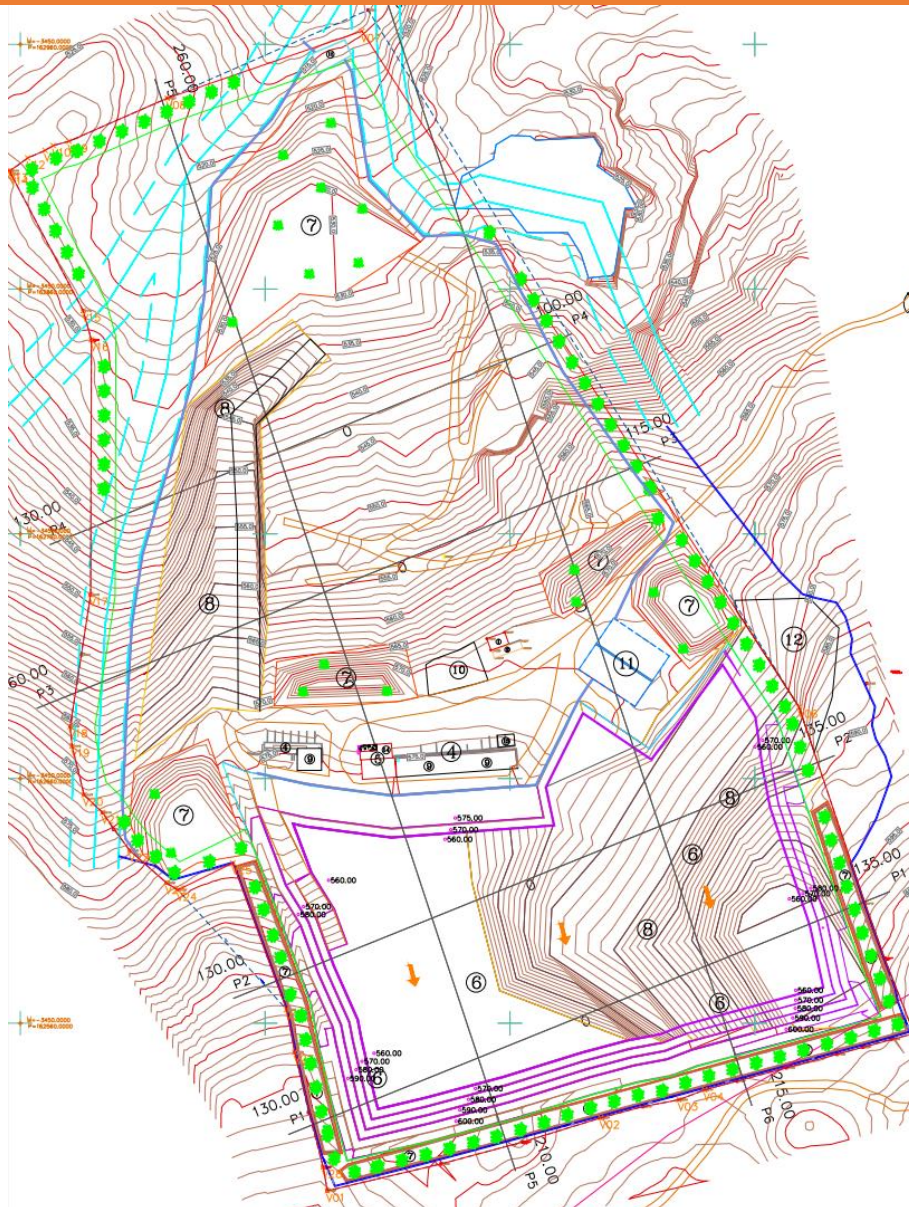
Planta de Escavação – Exploração a 35 Anos.
